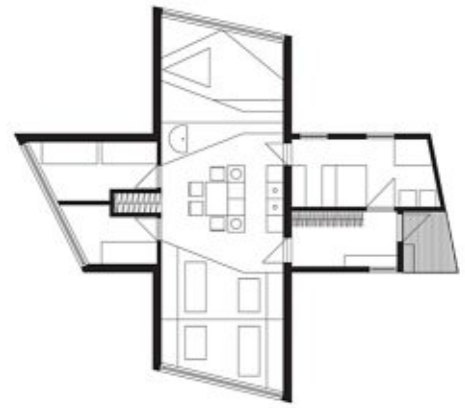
82 Grundriss Gemeinschafts- Lodge
